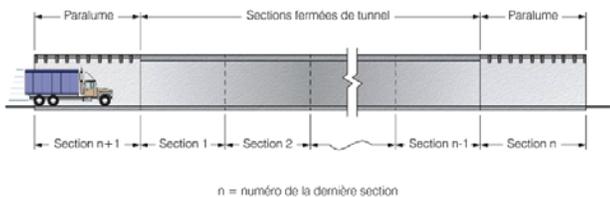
Sectionnement d'un tunnel avec parallumes
